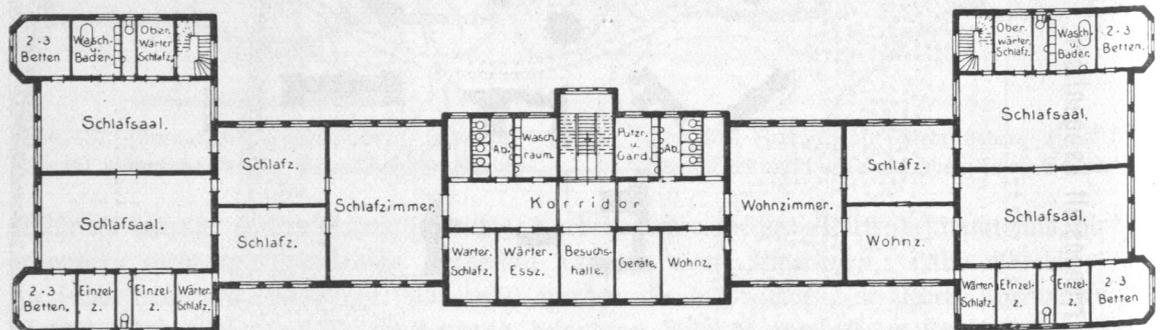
Irrenanstalt Langenhorn, Pflegehaus für 150 Männer und 19 Wärter, Obergeschoß, Grundriß.
